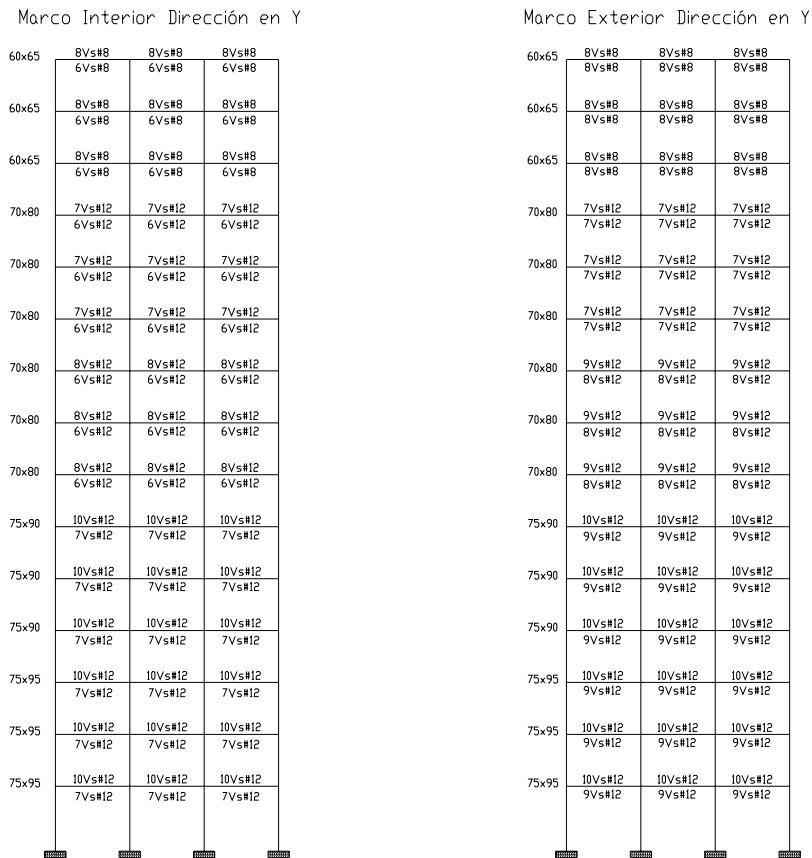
Armado de los extremos de las Vigas de Marcos en Dirección Y para el Edificio A.
